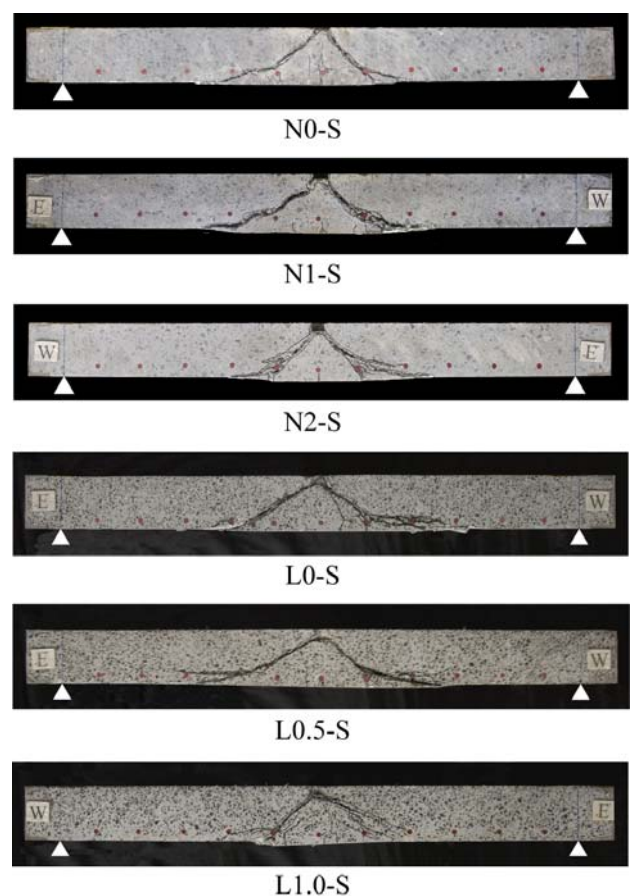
静載荷実験後の各試験体切断面のひび割れ状況
